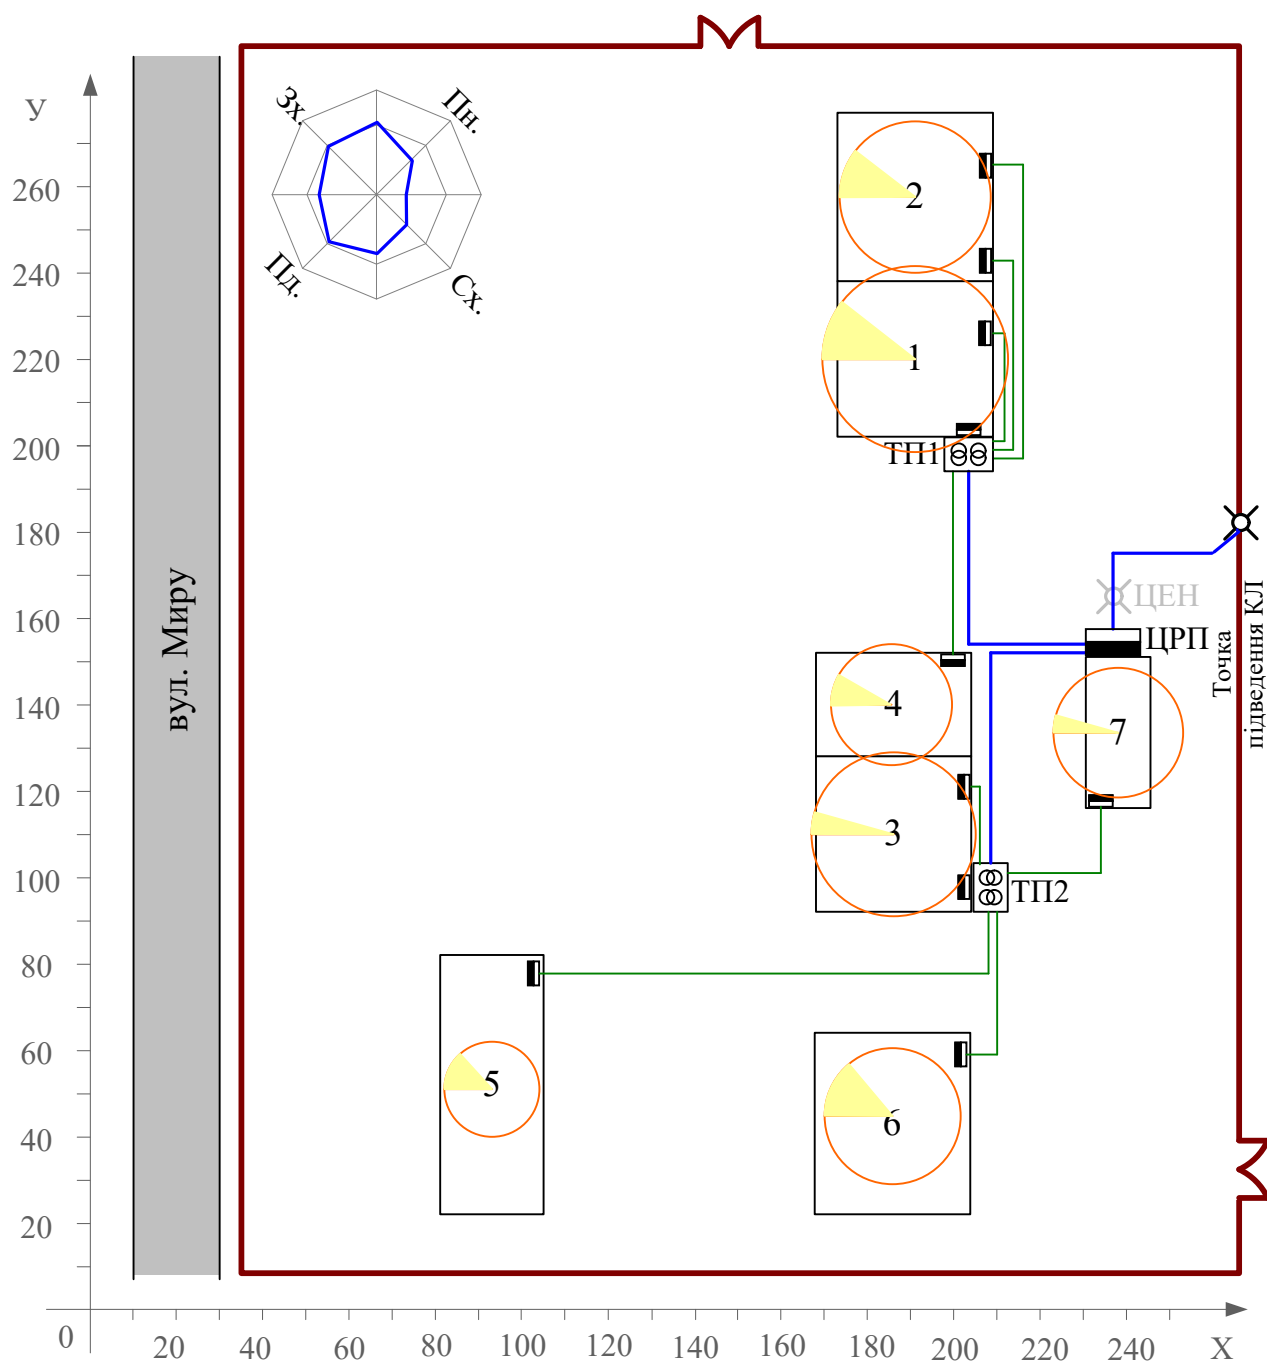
Генплан будівельно-монтажного управління №8
